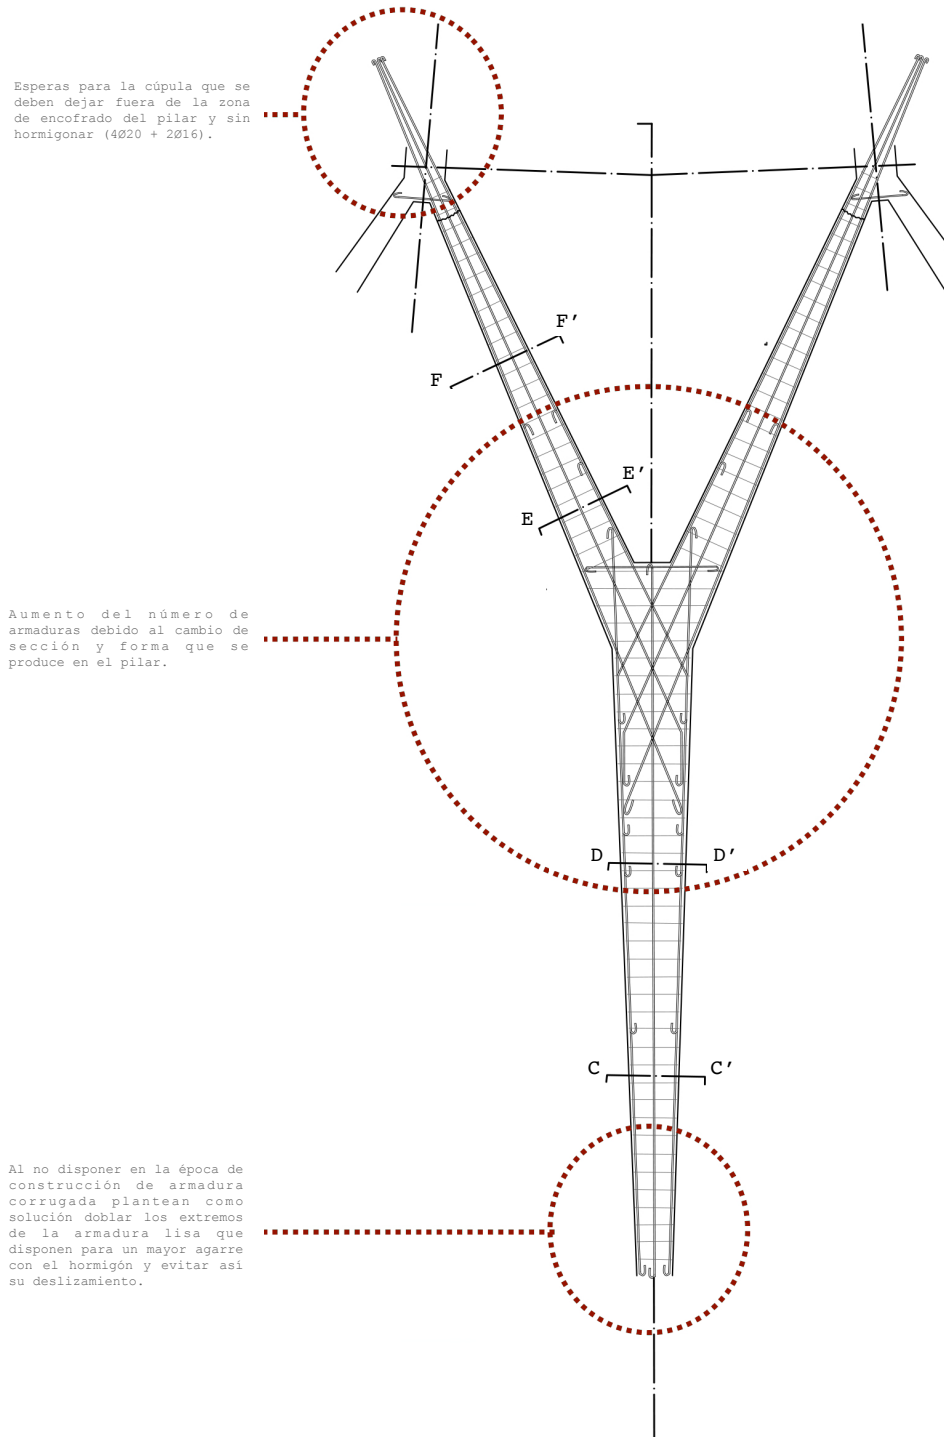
Detalle constructivo que muestra la variación de la sección del pilar a lo largo de todo su recorrido. Dibujo de autor.
